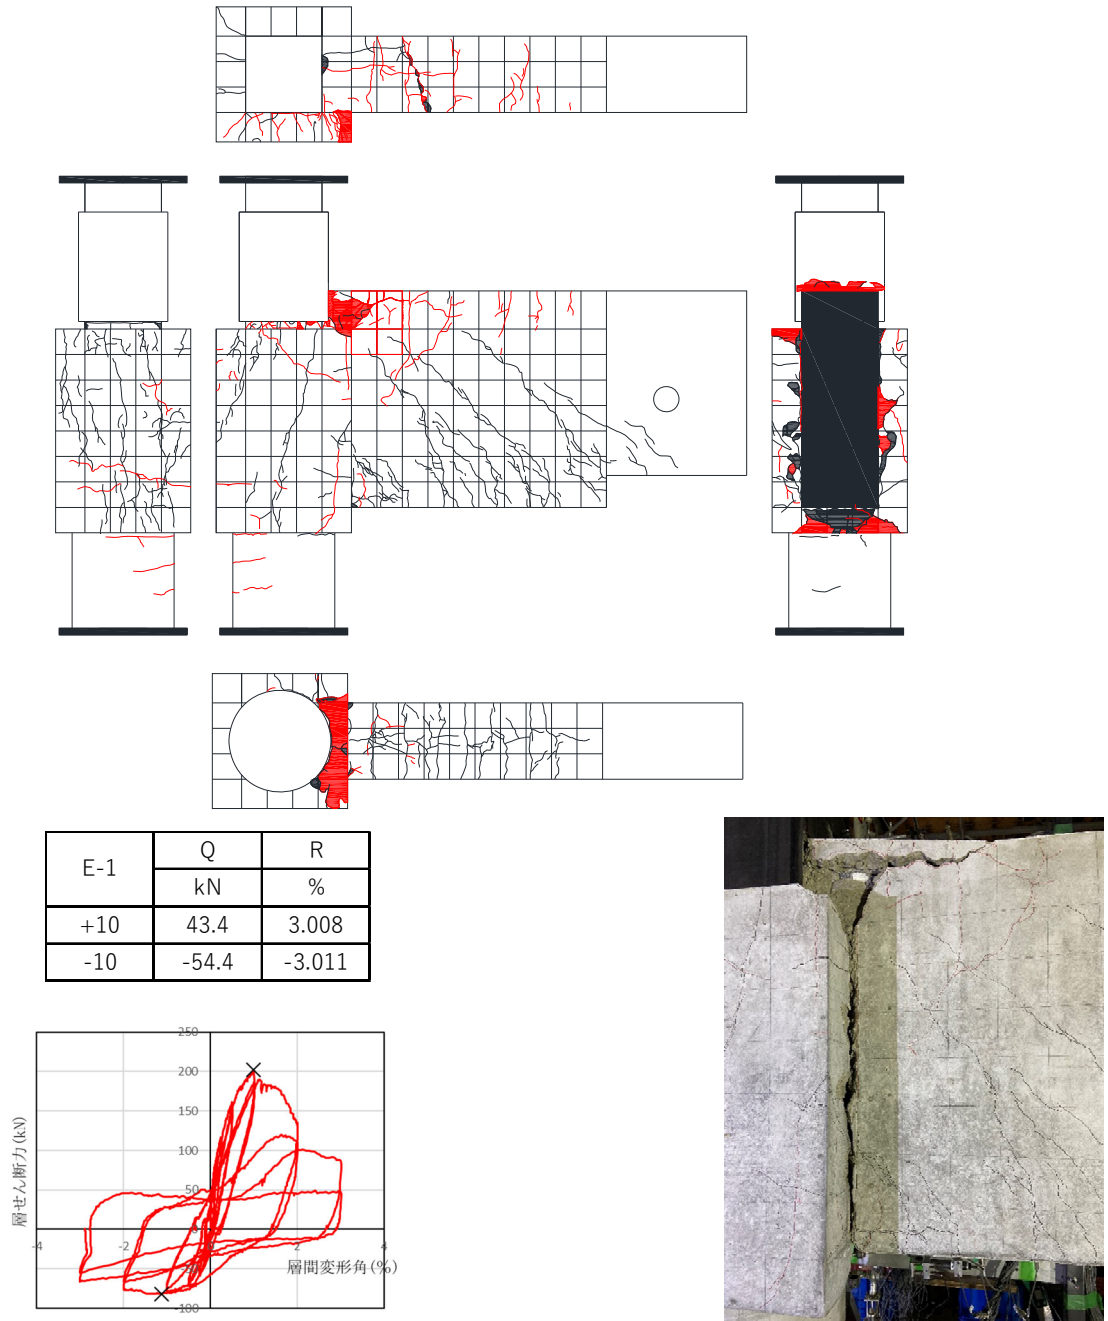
E-1 ひび割れ状況 (7Cycle)
